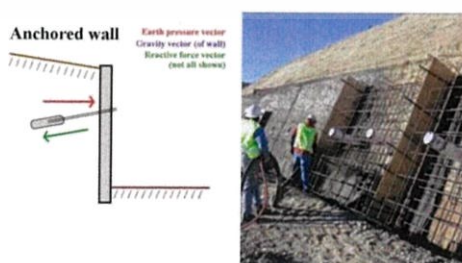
กำแพงกันดิน Piling Wall [3]
